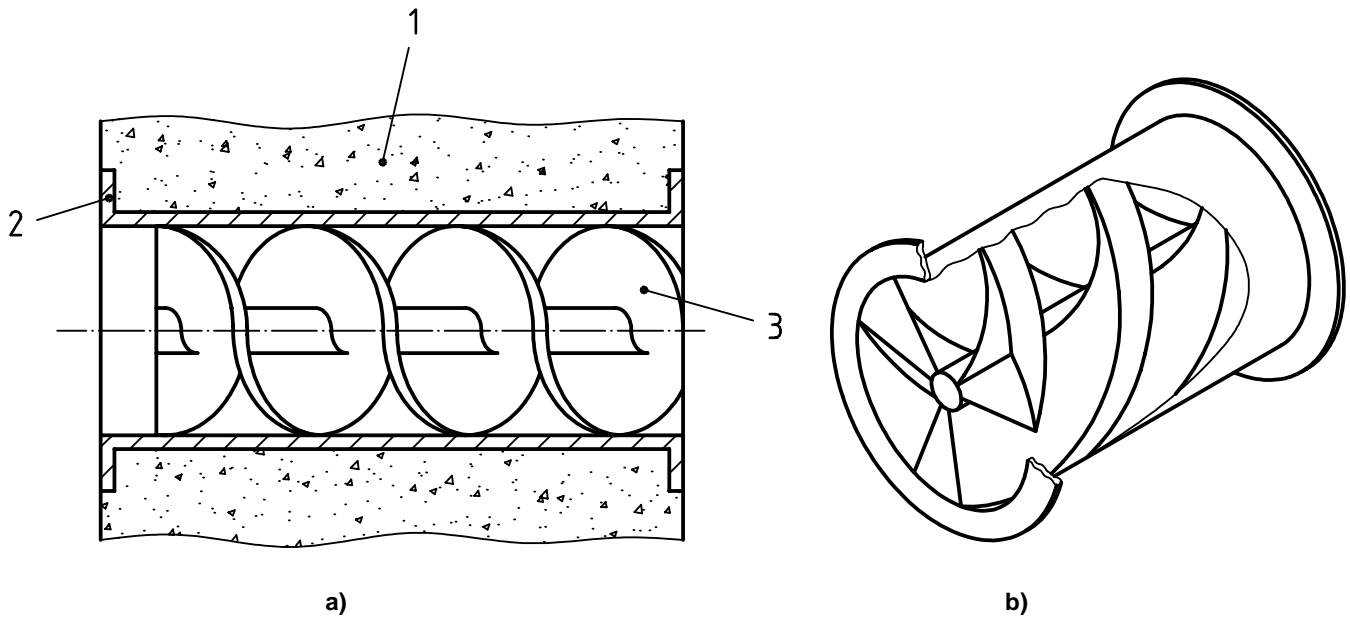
Exemples de traversées de ventilation conventionnelles avec des protections complémentaires disposées à l'extérieur de la paroi de l'enceinte
